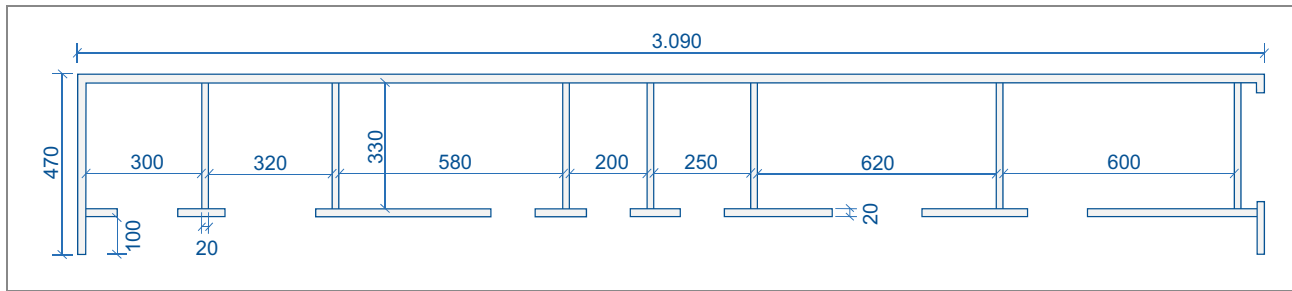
Grundriss der Schaltstation<sup>8</sup>
